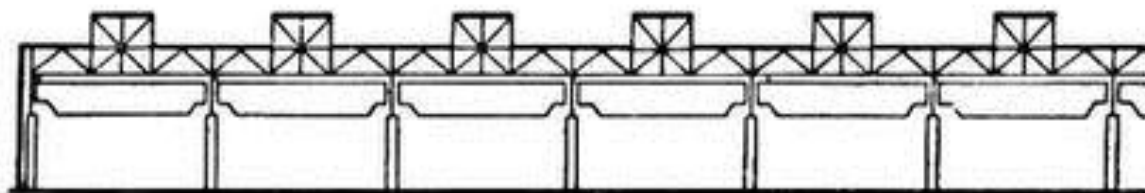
Одноэтажное многопролётное крановое здание со световыми фонарями
